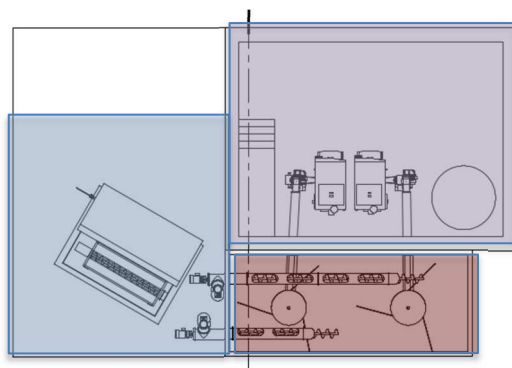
Plan d'implantation : trappe d'alimentation, silo préfabriqué et chaufferie existante
